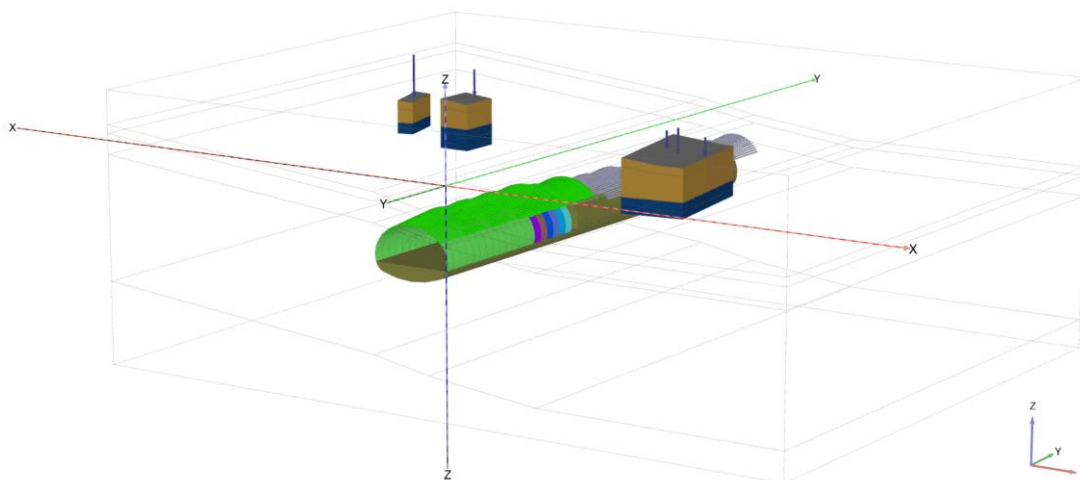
Modelo tridimensional da escavação e suporte, com consideração do faseamento construtivo e ganho de rigidez do betão projetado com o tempo
